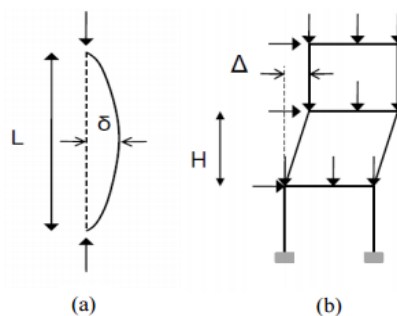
Tolerancias para la verticalidad de las columnas exteriores normales a la línea de edificación. [7]
